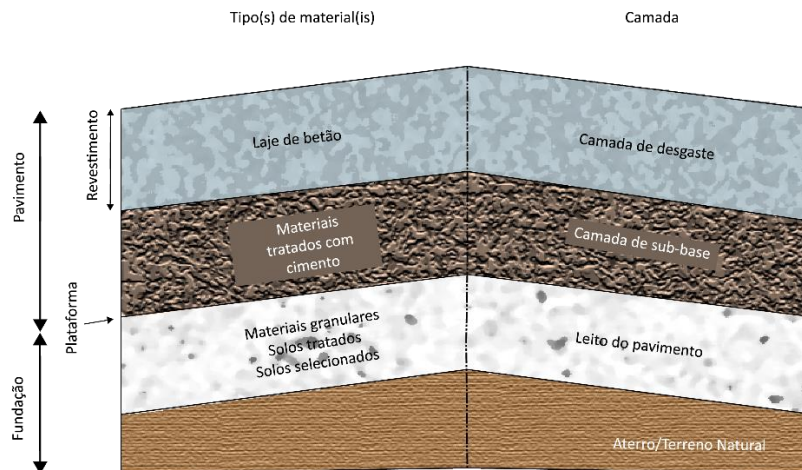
Constituição de um pavimento rígido (adaptado de ANTUNES, 2005)
